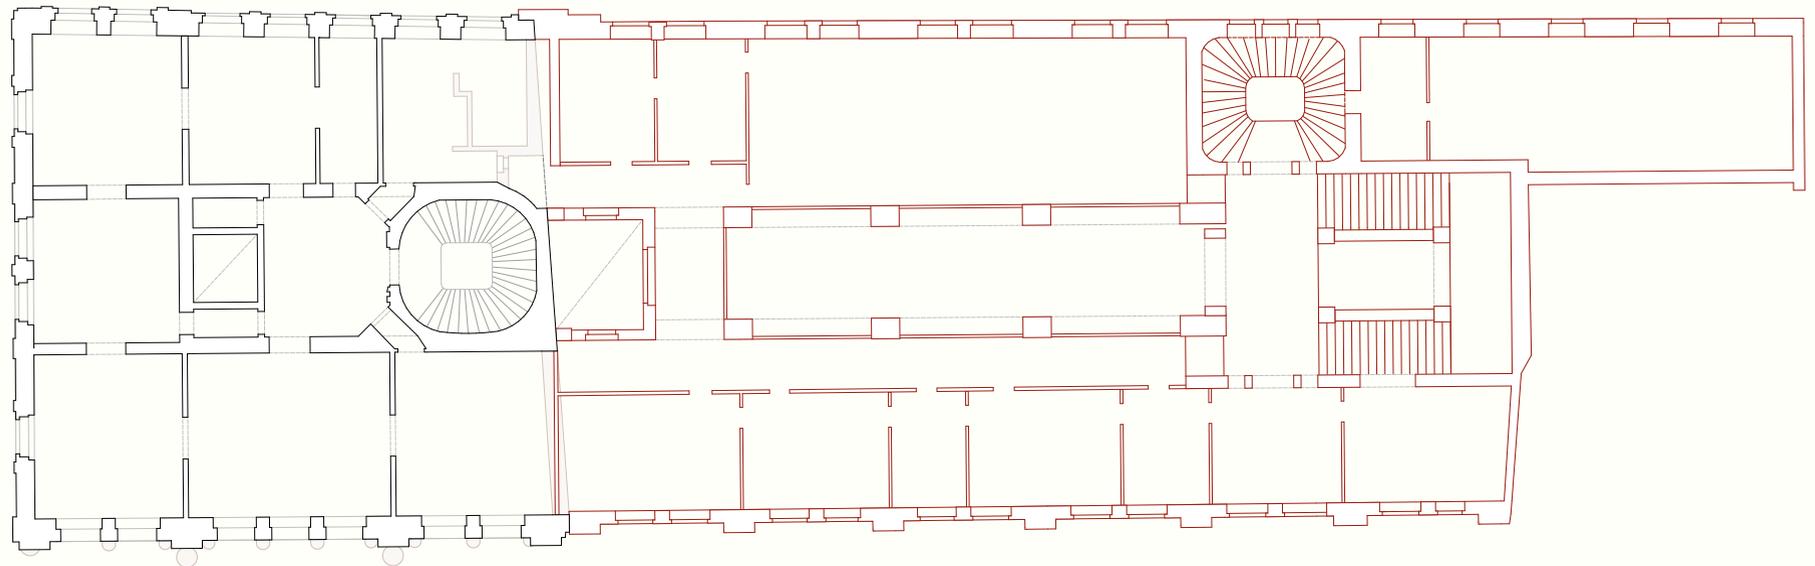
Haus am Hof 4 inkl. Zubau, Grundriss 1. Stock ab 1912
